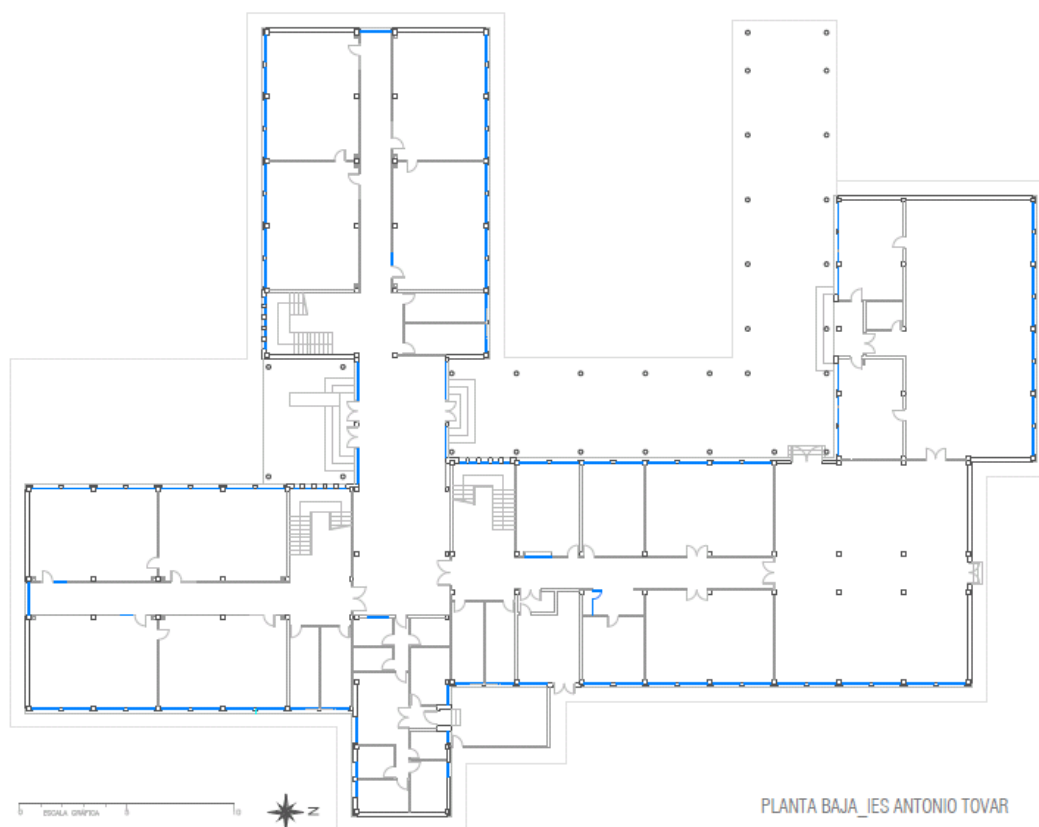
Planta baja del IES Antonio Tovar. Archivo Histórico Provincial de Valladolid, Sección Educación, caja 81/25.
